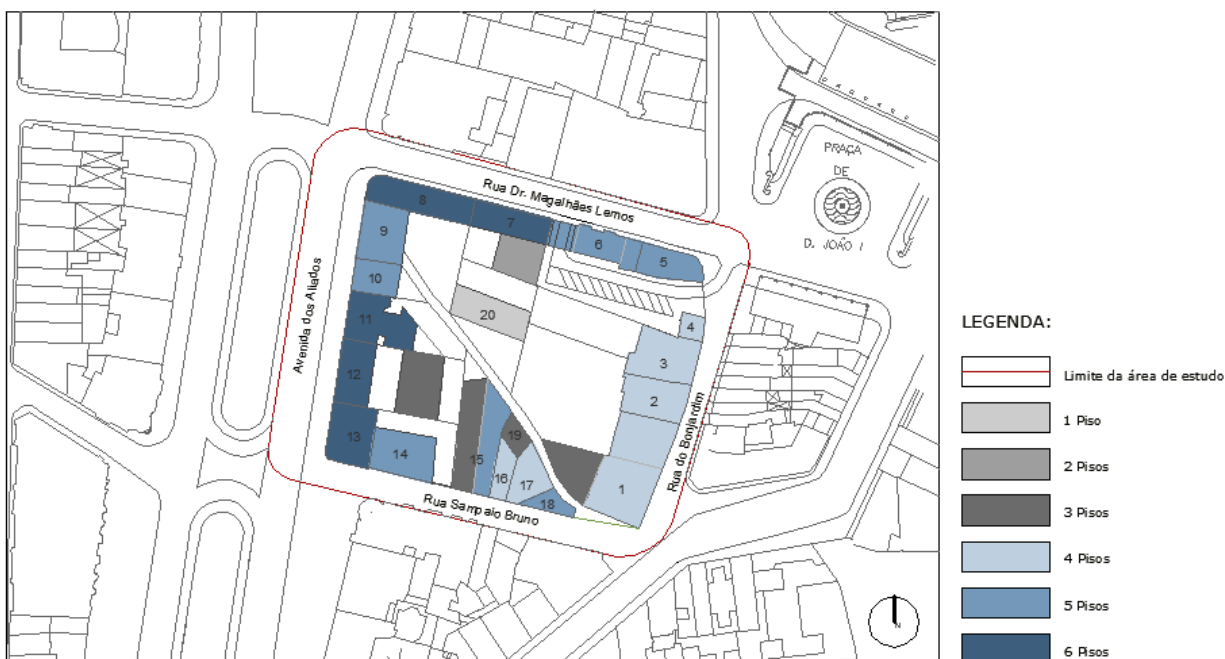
Planta da distribuição do número de pisos. Fonte: Autor.
